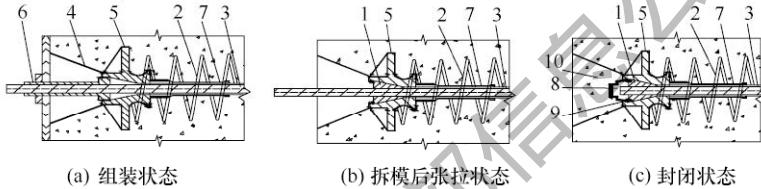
全封闭垫板连体式锚具系统构造示意
